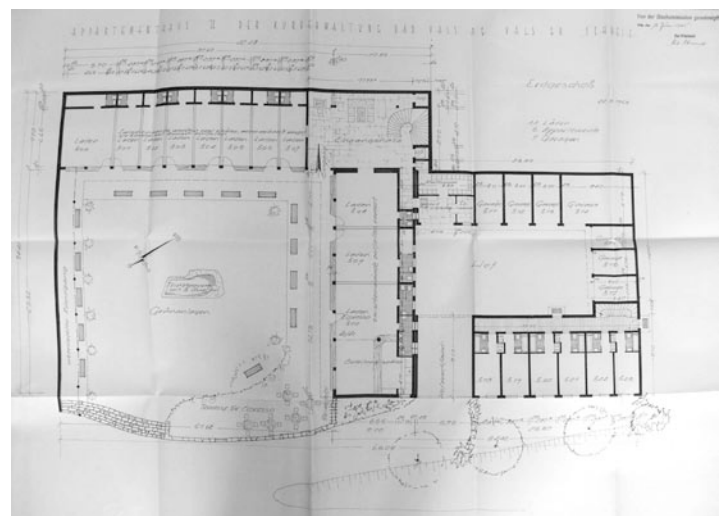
Appartementhaus III, Bad Vals, Grundriss Erdgeschoss, Rudolf Berger, 1965.
